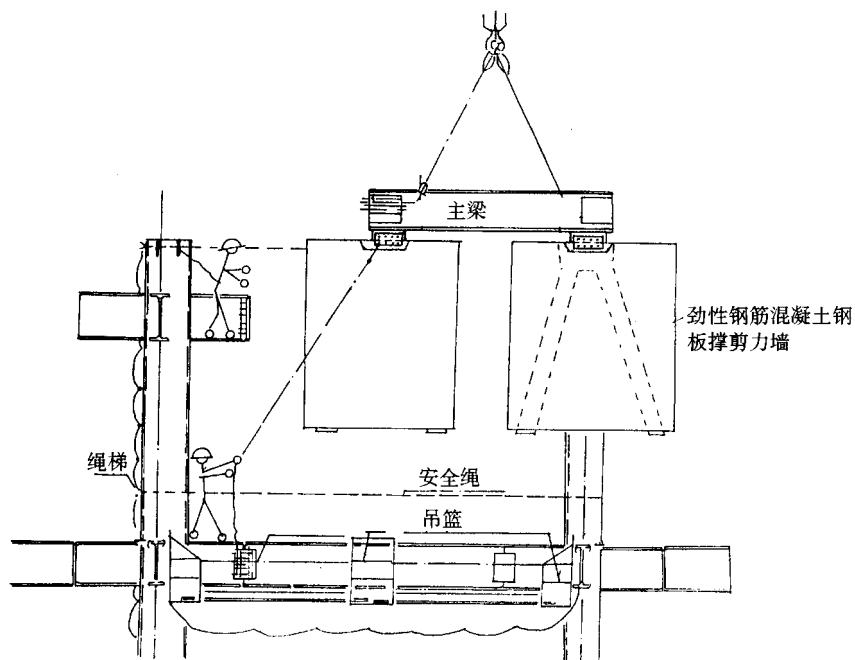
钢主梁与劲性钢筋混凝土剪力墙组拼安装示意图
